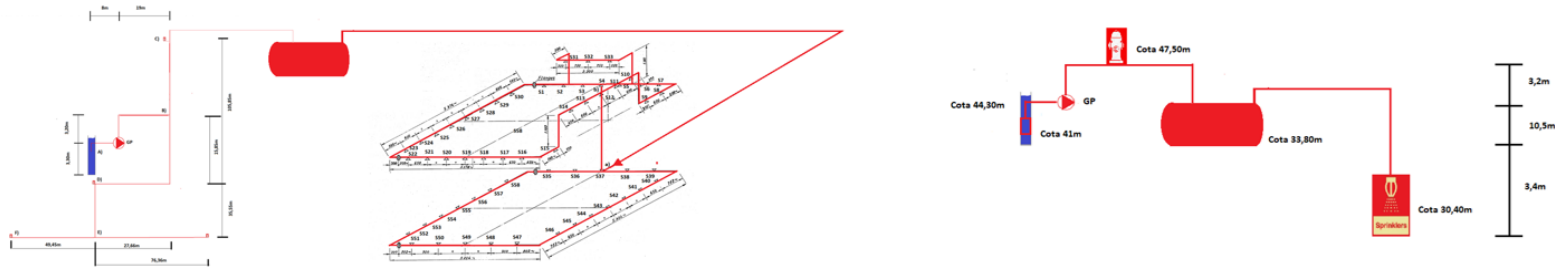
Anexo II - Cálculo rede extinção de incêndio - Sprinklers
